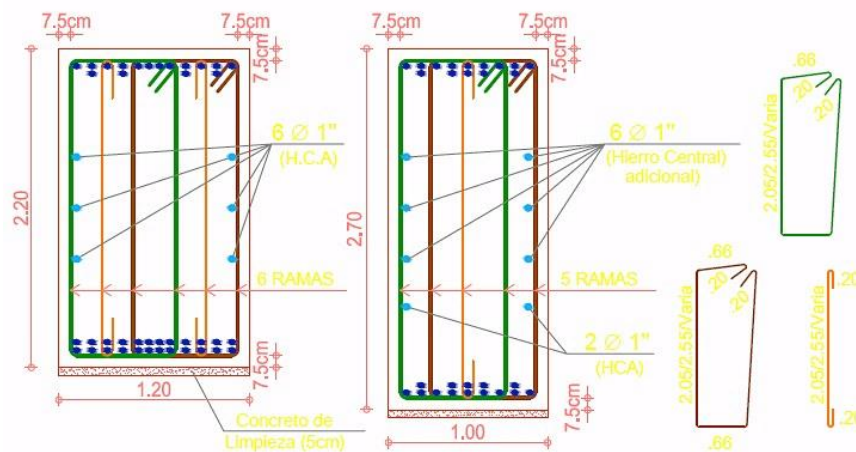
Sección transversal de una viga cimiento tipo 1 perteneciente a la losa de cimentación PC-1 (1.2 x 2.2 ó 1.0 x 2.7 m).
